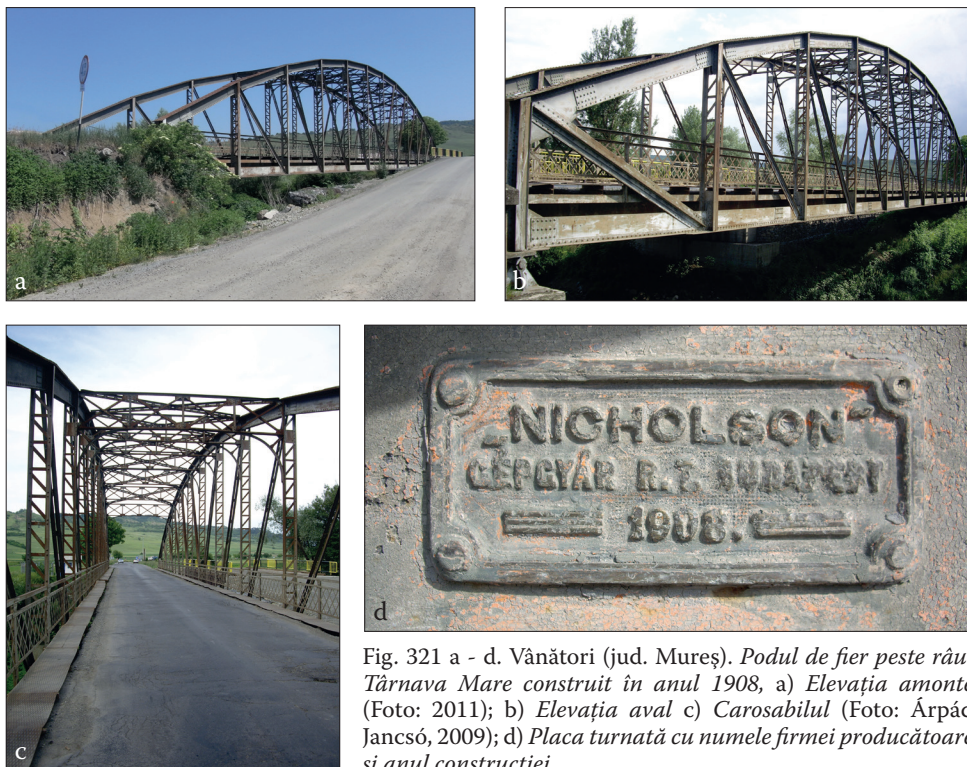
a - d. Vânători (jud. Mureș). Podul de fier peste râul Târnavă Mare construit în anul 1908, a) Elevația amonte (Foto: 2011); b) Elevația aval (Foto: Árpád Jancsó, 2009); c) Carosabilul (Foto: Árpád Jancsó, 2009); d) Placa turnată cu numele firmei producătoare și anul construcției
